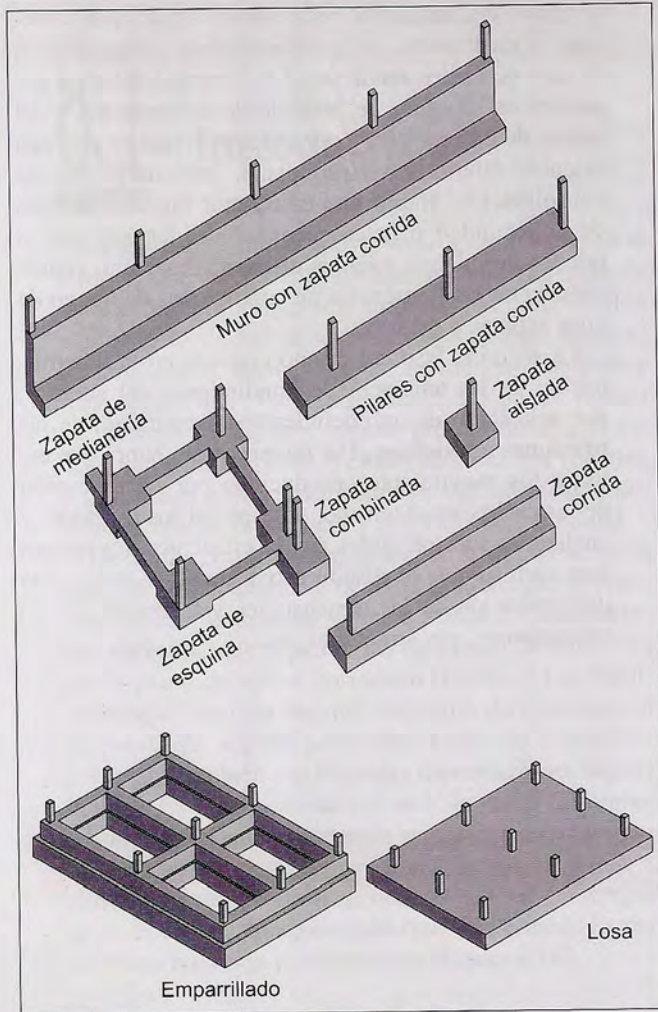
Tipos de cimentación directa (Calavera, 1987).
